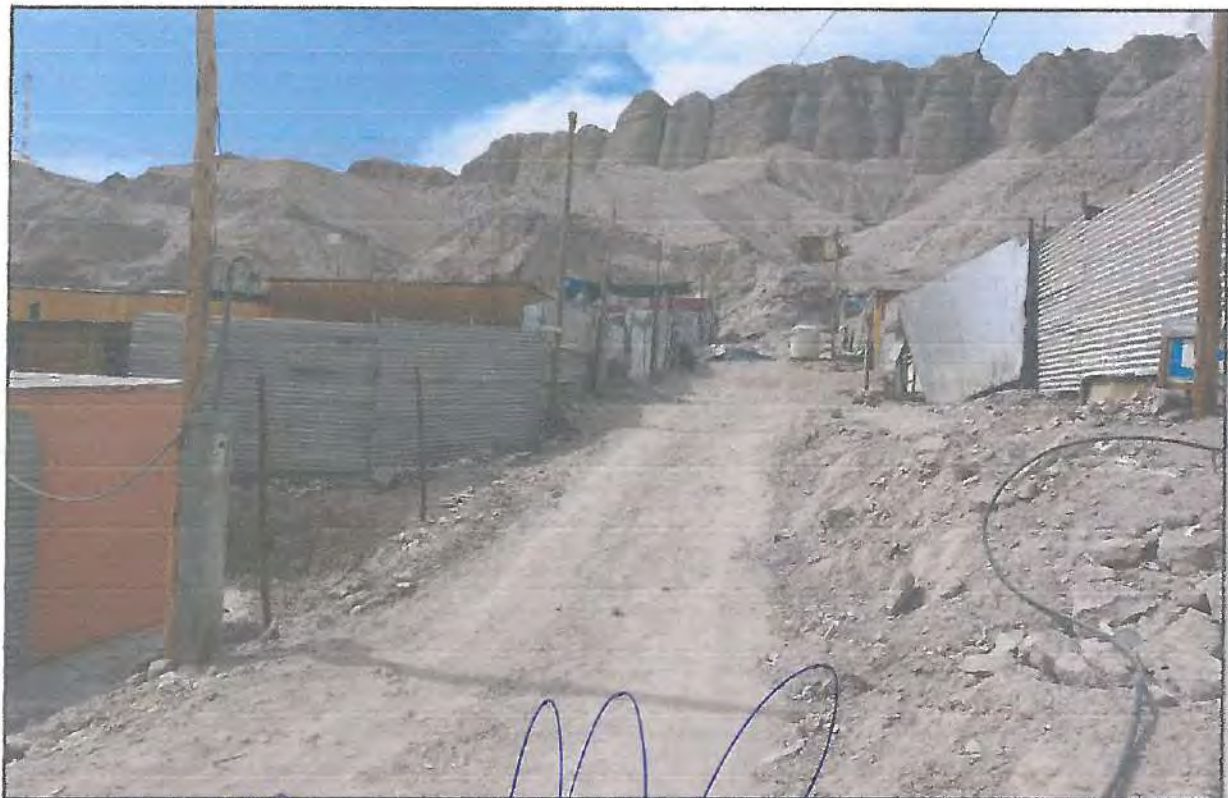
Vista de la Calle N° 10 entre la manzana O y P
